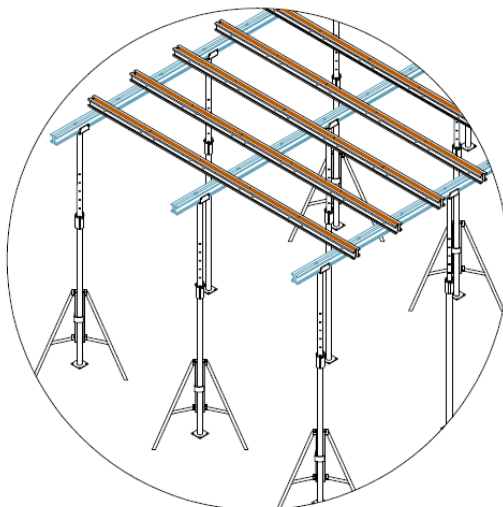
Esquema de escoramento em vigas – Torre B.
